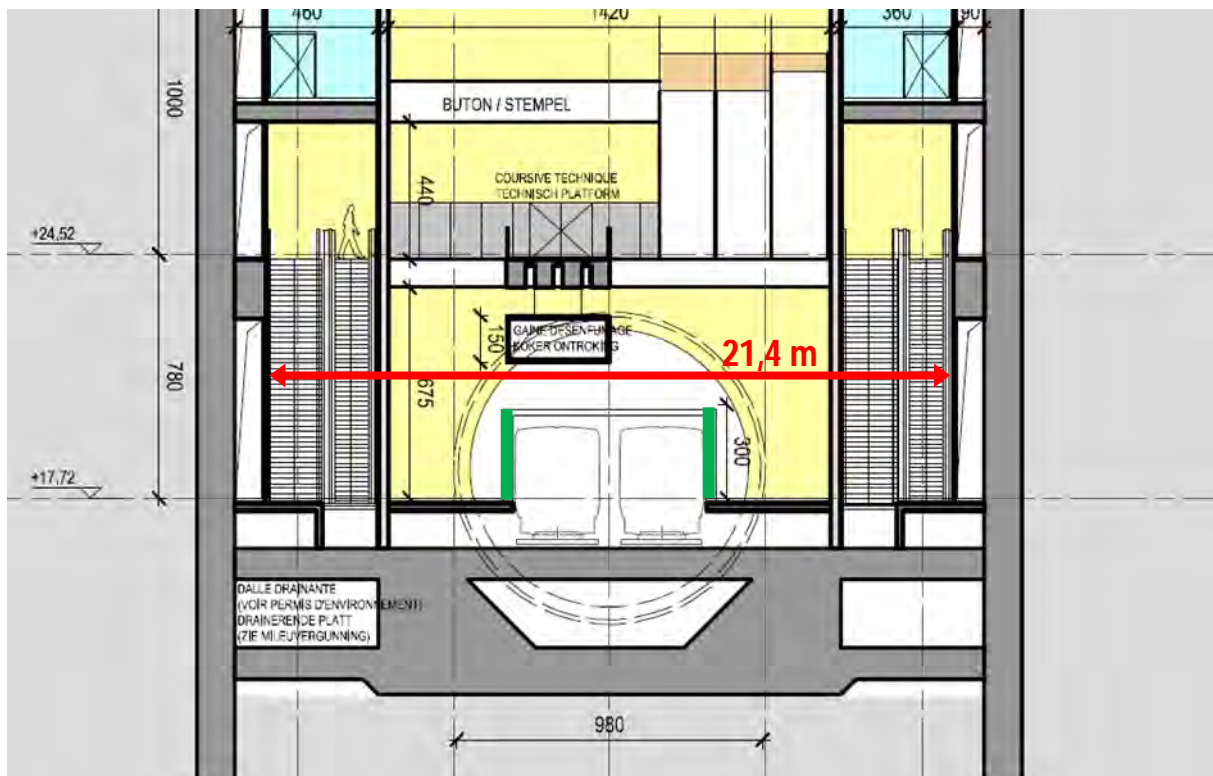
Coupe transversale au niveau des quais (côté nord de la station) (Source :
